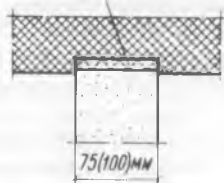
Пример упругого соединения, обеспечивающего звукопреграждающий шов между общей стеной из ячеистого бетона и перекрытием из плотного бетона
